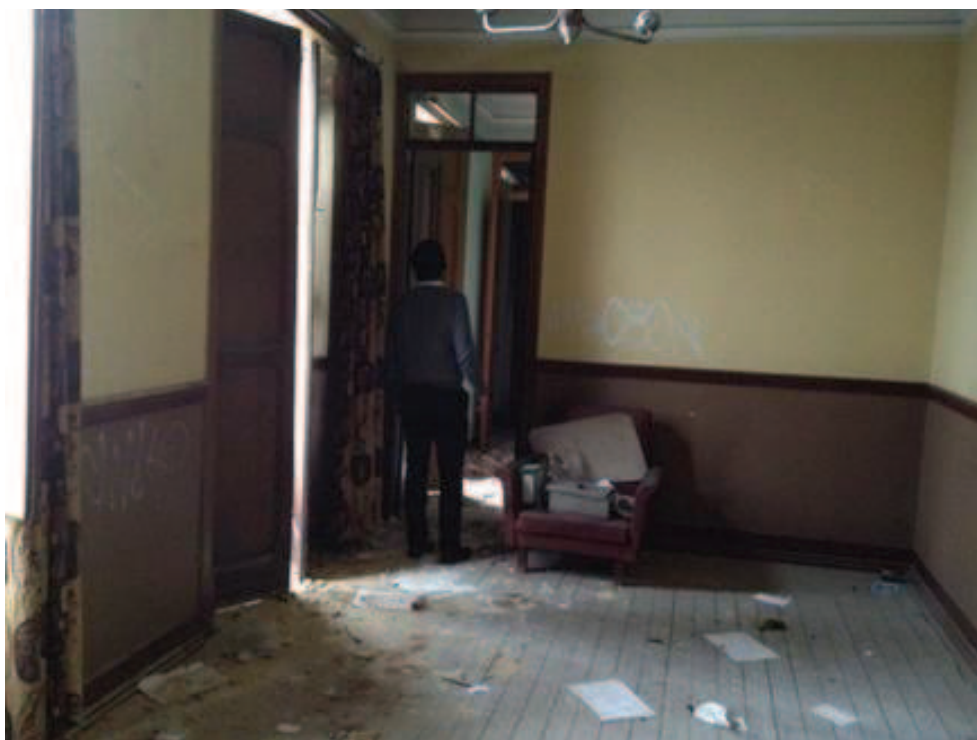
Interior – pavimentos e paredes deterioradas
